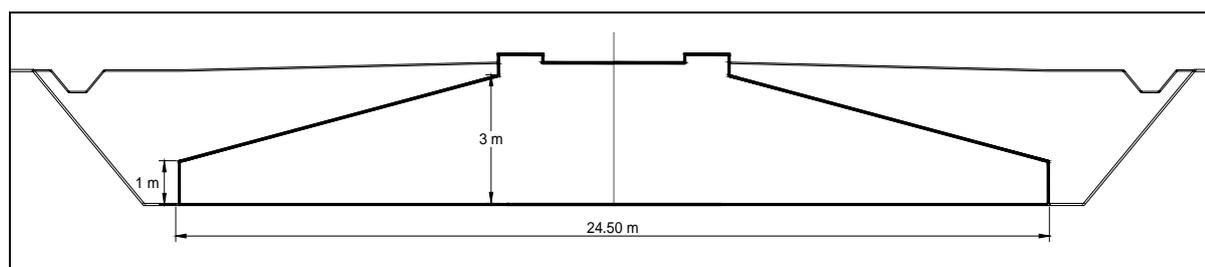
Tipico sezione fondazione Aerogeneratore.
